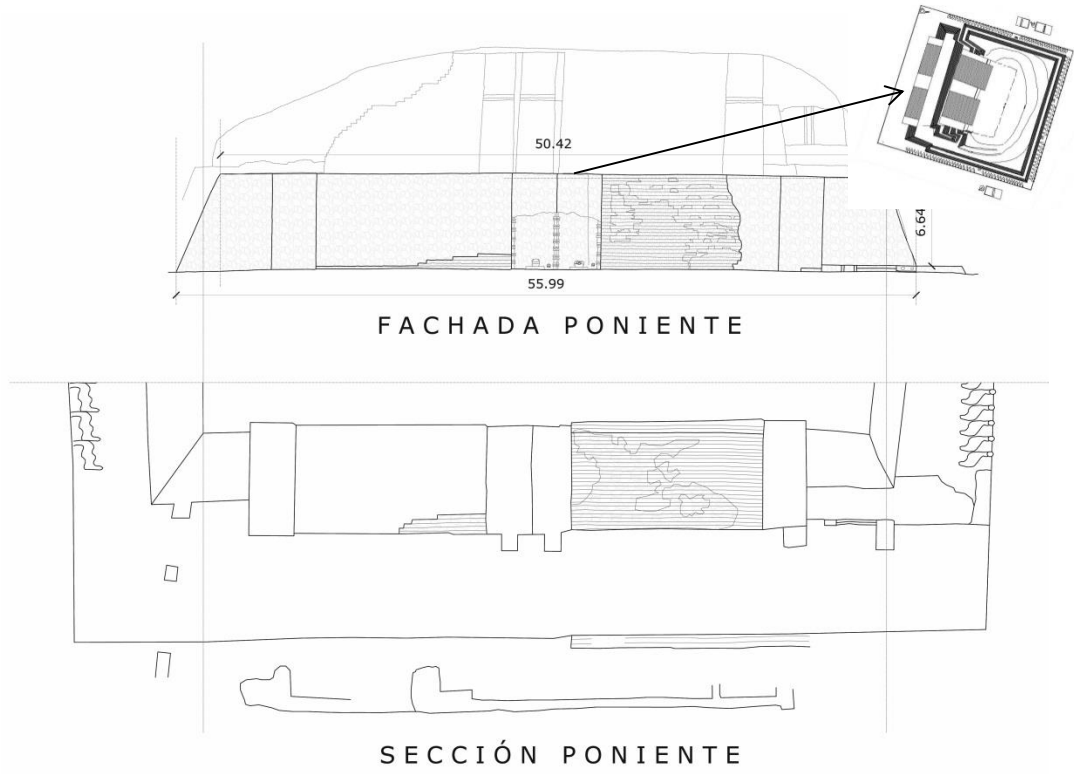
Plano de fachada de la fachada poniente (frente del edificio)
